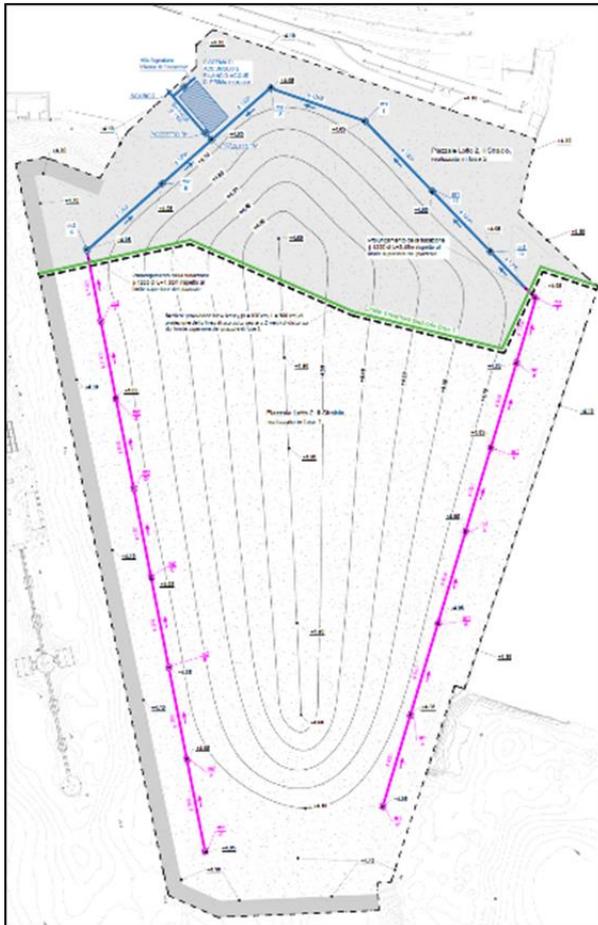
Nuova cassa di colmata. Planimetria opere in progetto relative alle Fasi 1 e 2 del Loto 2- II Stralcio
